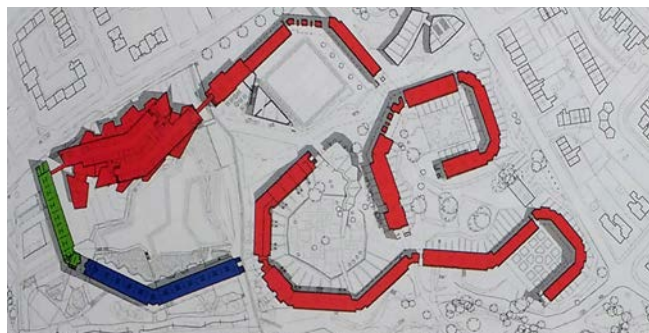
Planta de las próximas fases de Park Hill. En The Architect's Journal
